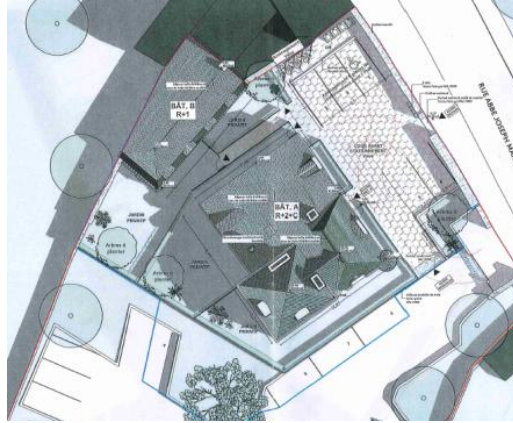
Plan masse du permis de construire accordé (Source : dossier du permis de construire)
